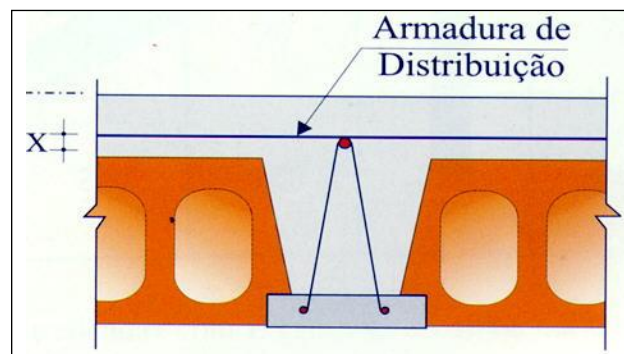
Laje pré-fabricada do tipo treliçada (FAULIM, 1998).
